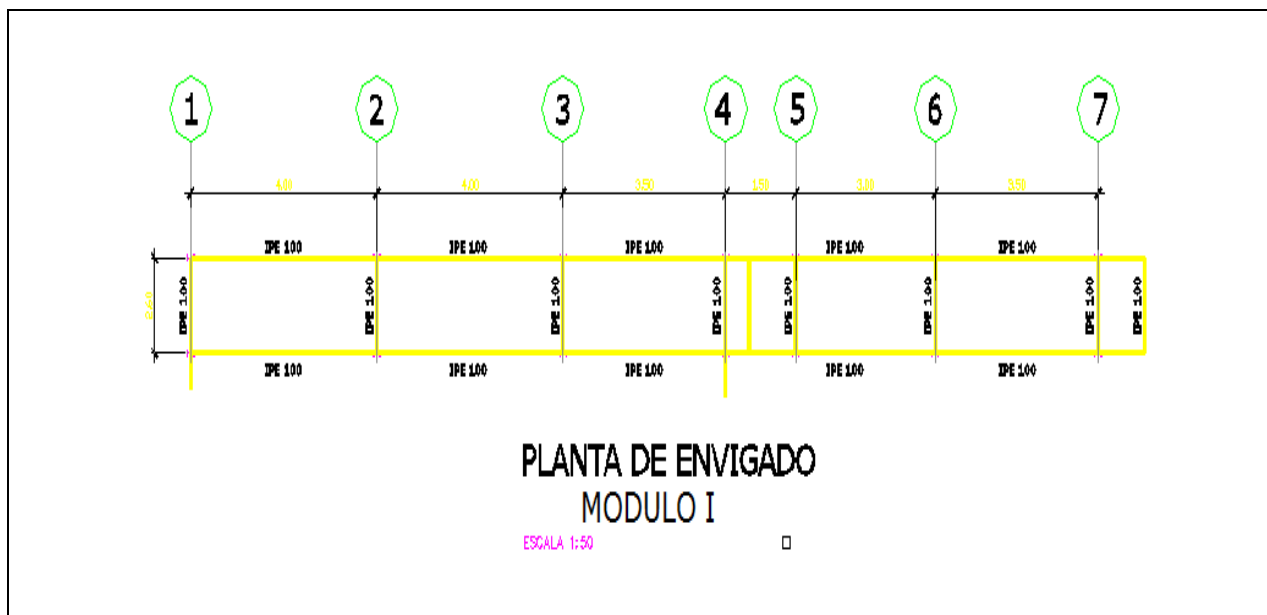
Planta de envigado modulo I. Fuente: Propia.
